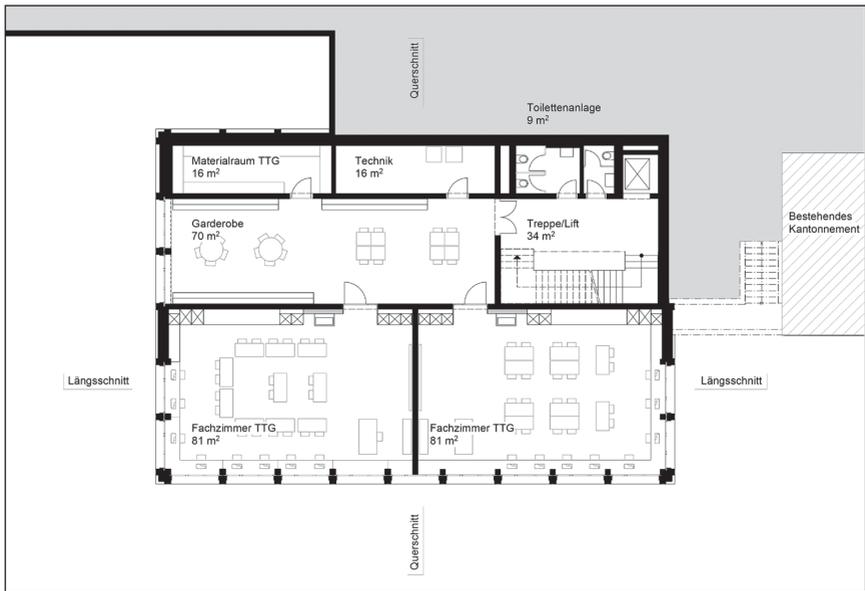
Grundriss Untergeschoss, ohne Masstab, Stand: 24.04.2024
